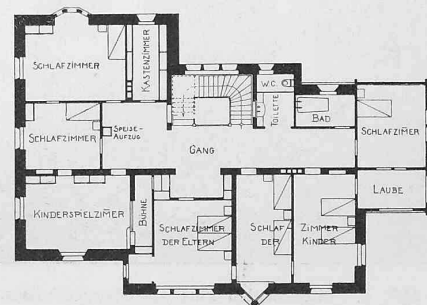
Grundriss vom ersten Obergeschoss. — Masstab 1:400.
